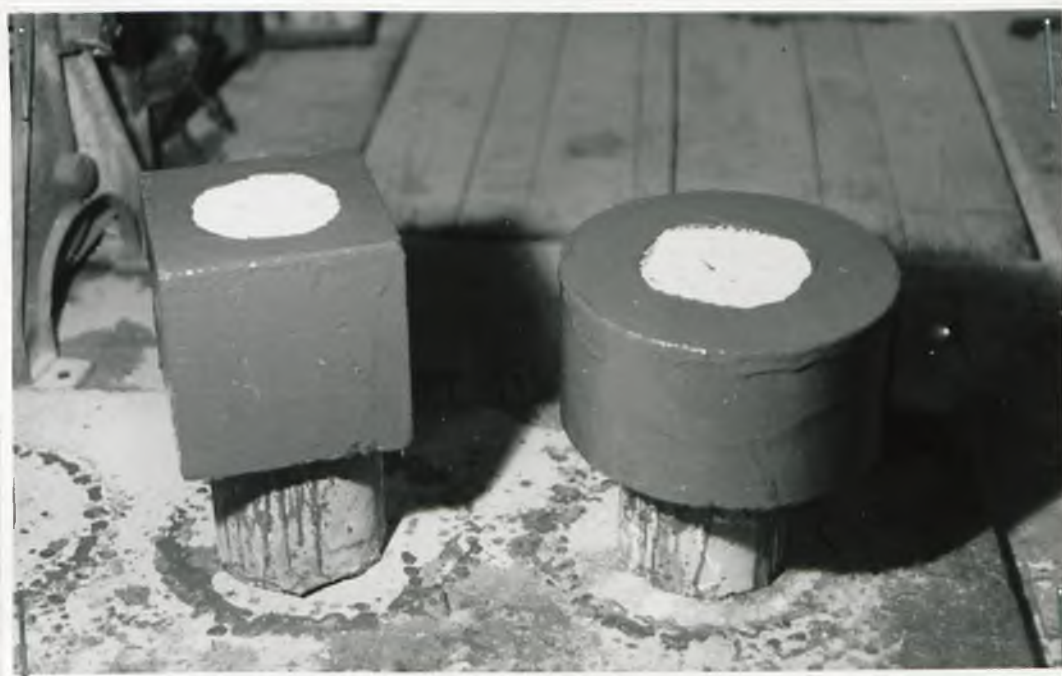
Próbki betonowe przeznaczone do badań wodoszczelności.
